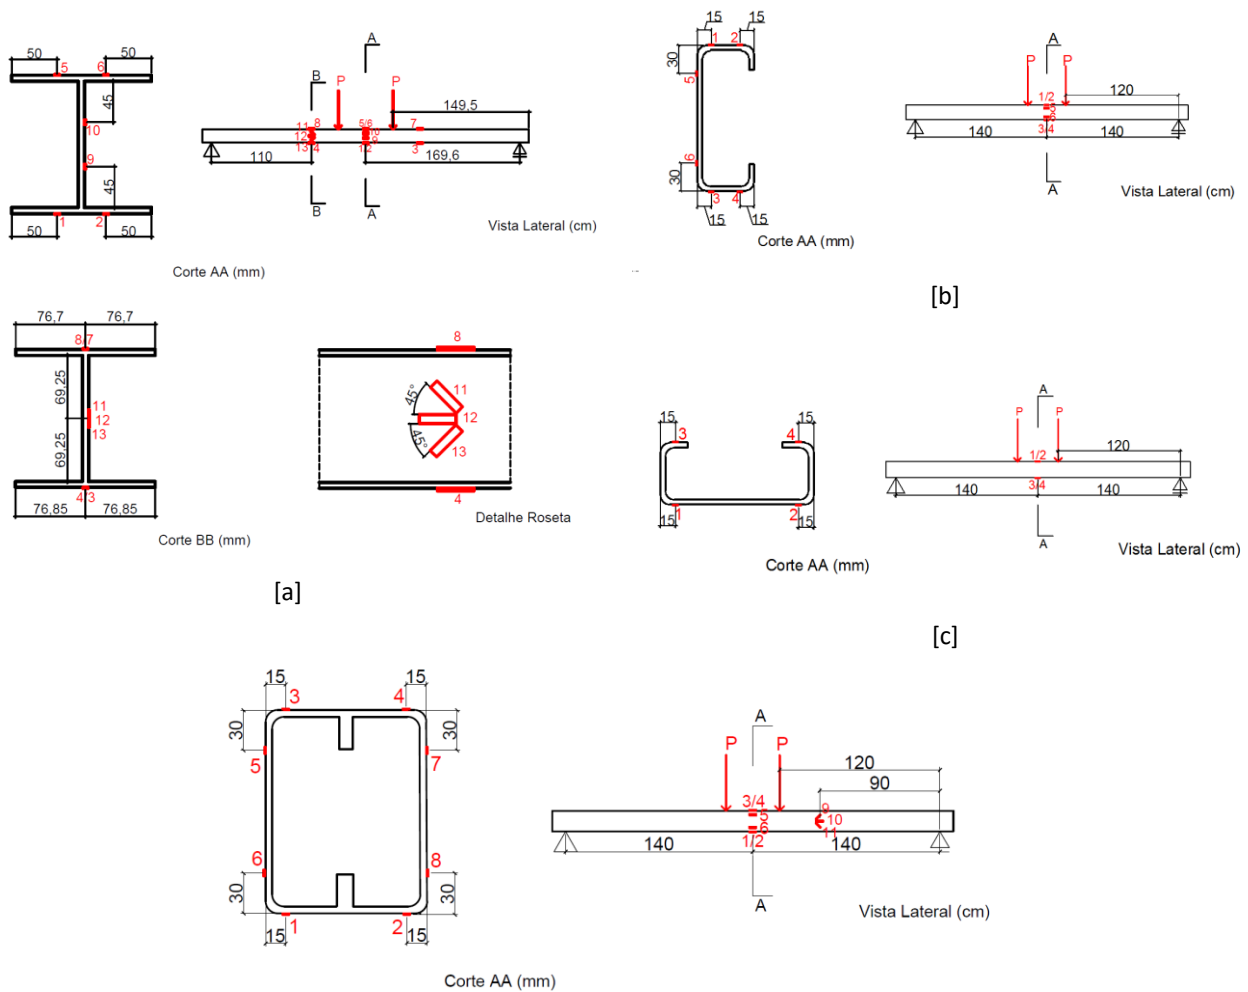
Esquema de aplicação de forças para o ensaio da (a) viga de seção “H” e (b) vigas em perfil formado a frio (dimensões em cm). FONTE: Autoria própria.
